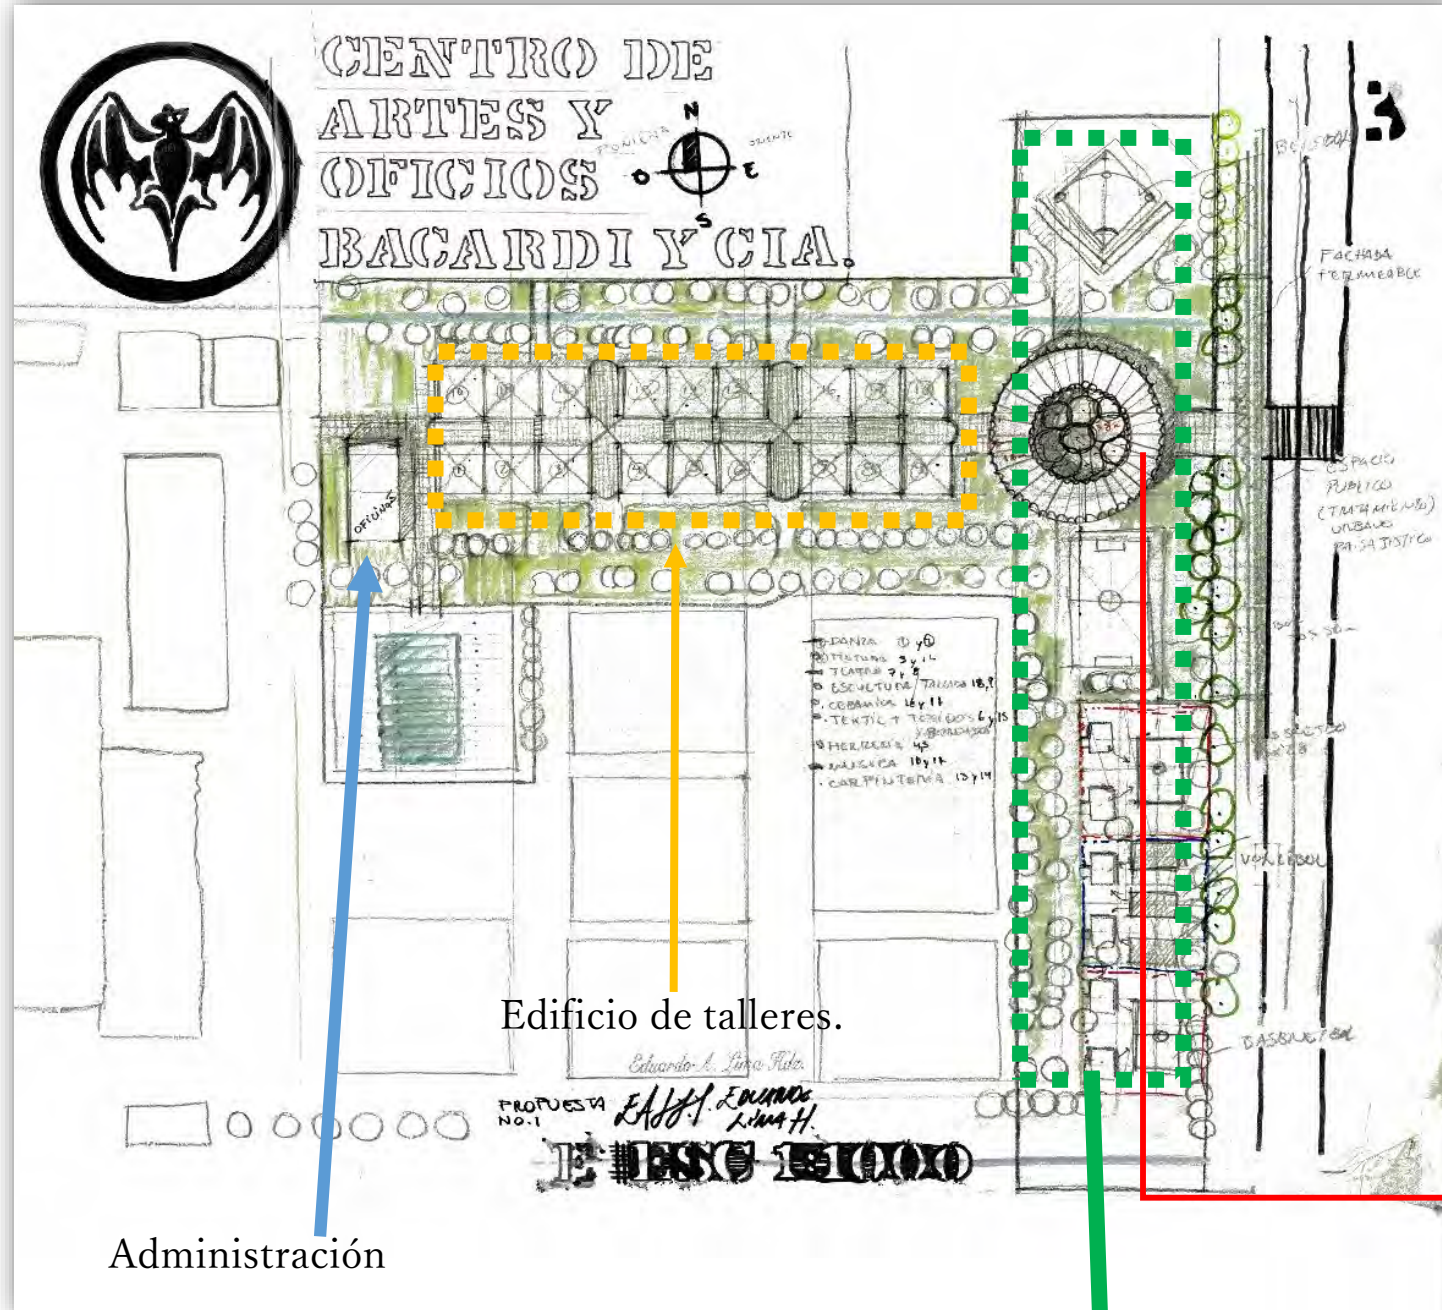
Primer Planta General de Conjunto Abril 2018 (intervenida)
